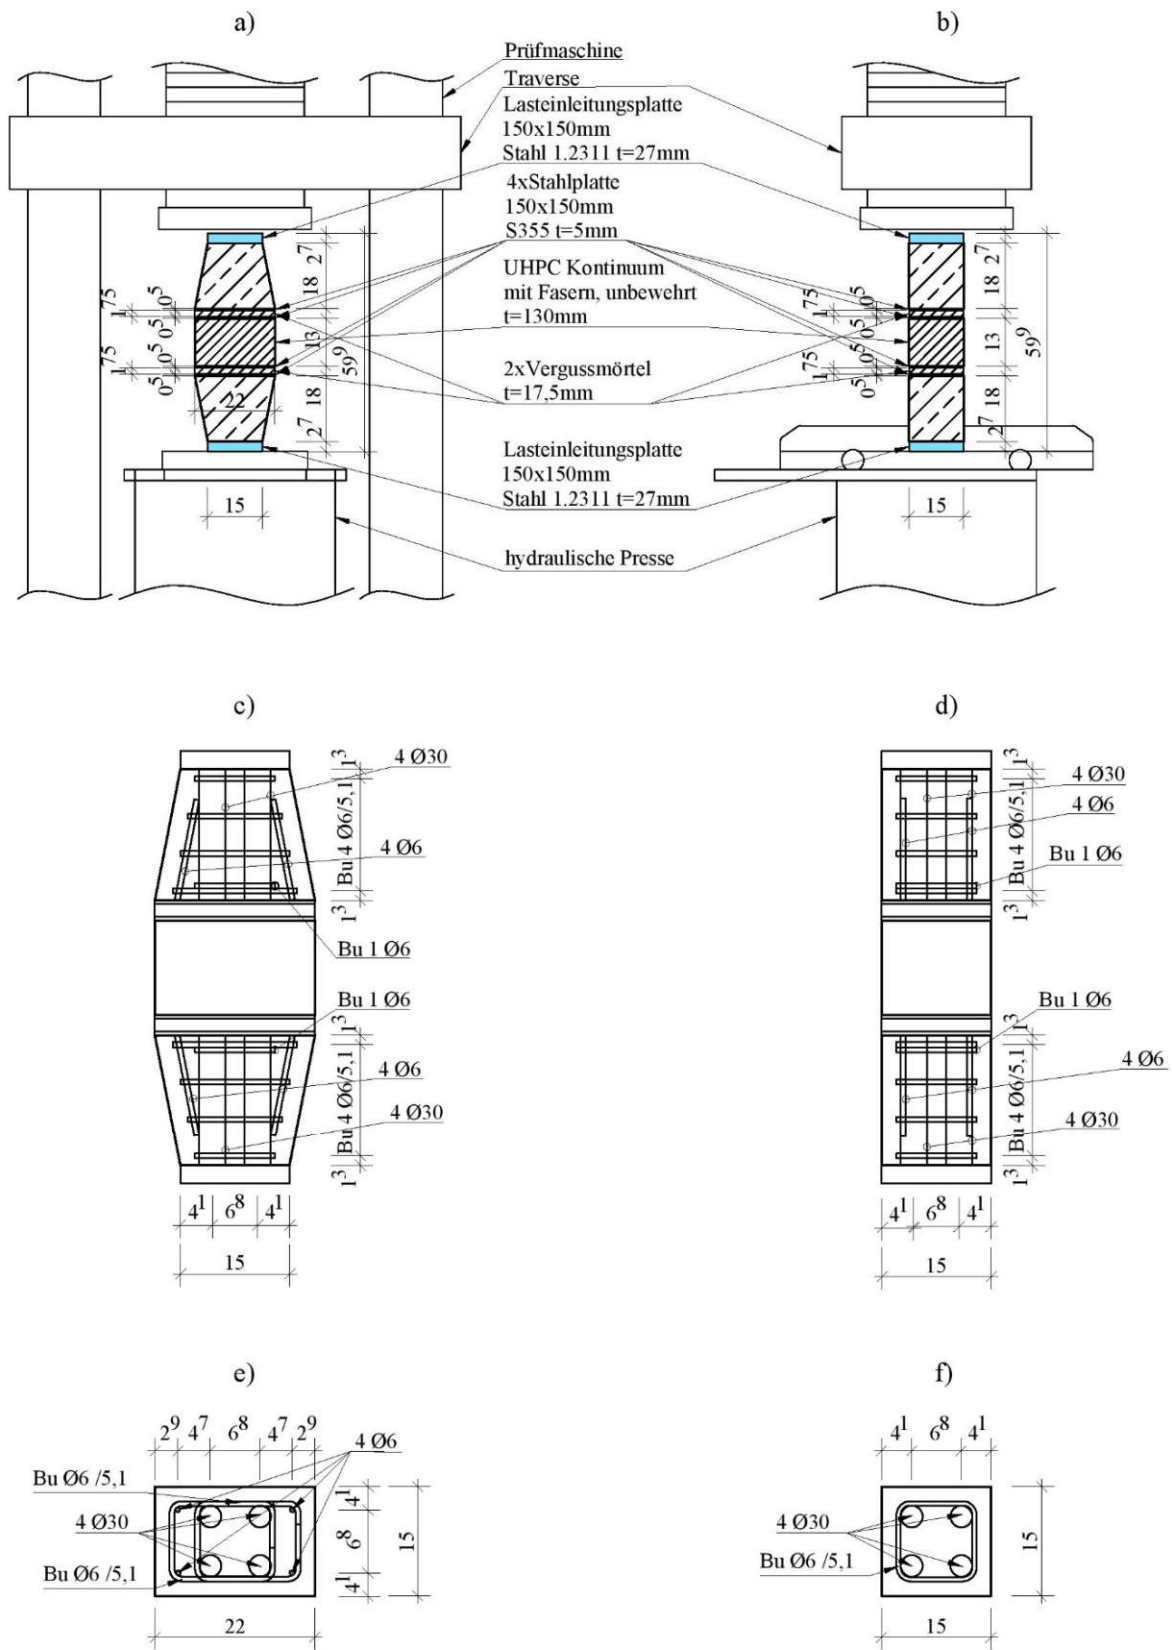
Stütze mit UHPC Kontinuum und Aufweitung a) Ansicht von vorne, b) Seitenansicht, c) Bewehrung im Aufriss von vorne, d) Bewehrung im Aufriss von der Seite, e) Bewehrung im Grundriss im Stoßbereich, f) Bewehrung im Grundriss im Lasteinleitungsbereich
